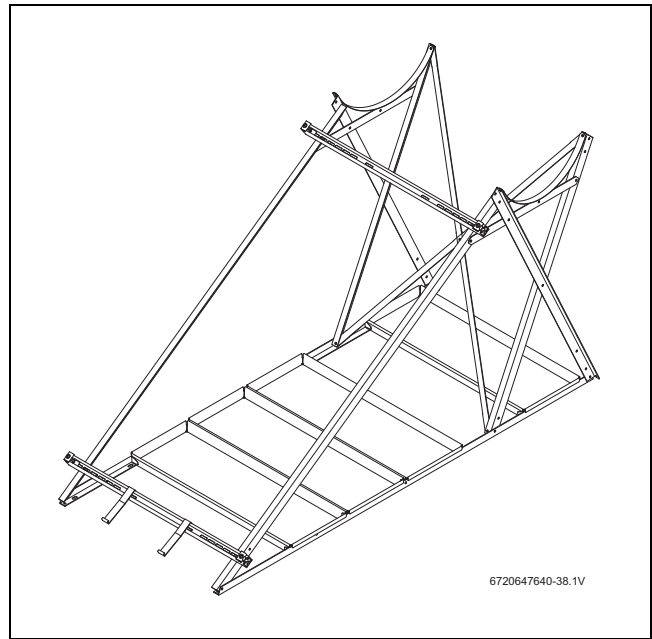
Soporte para tejado plano fija con placas de hormigón, medidas en mm (sistema de 150/200 I)
